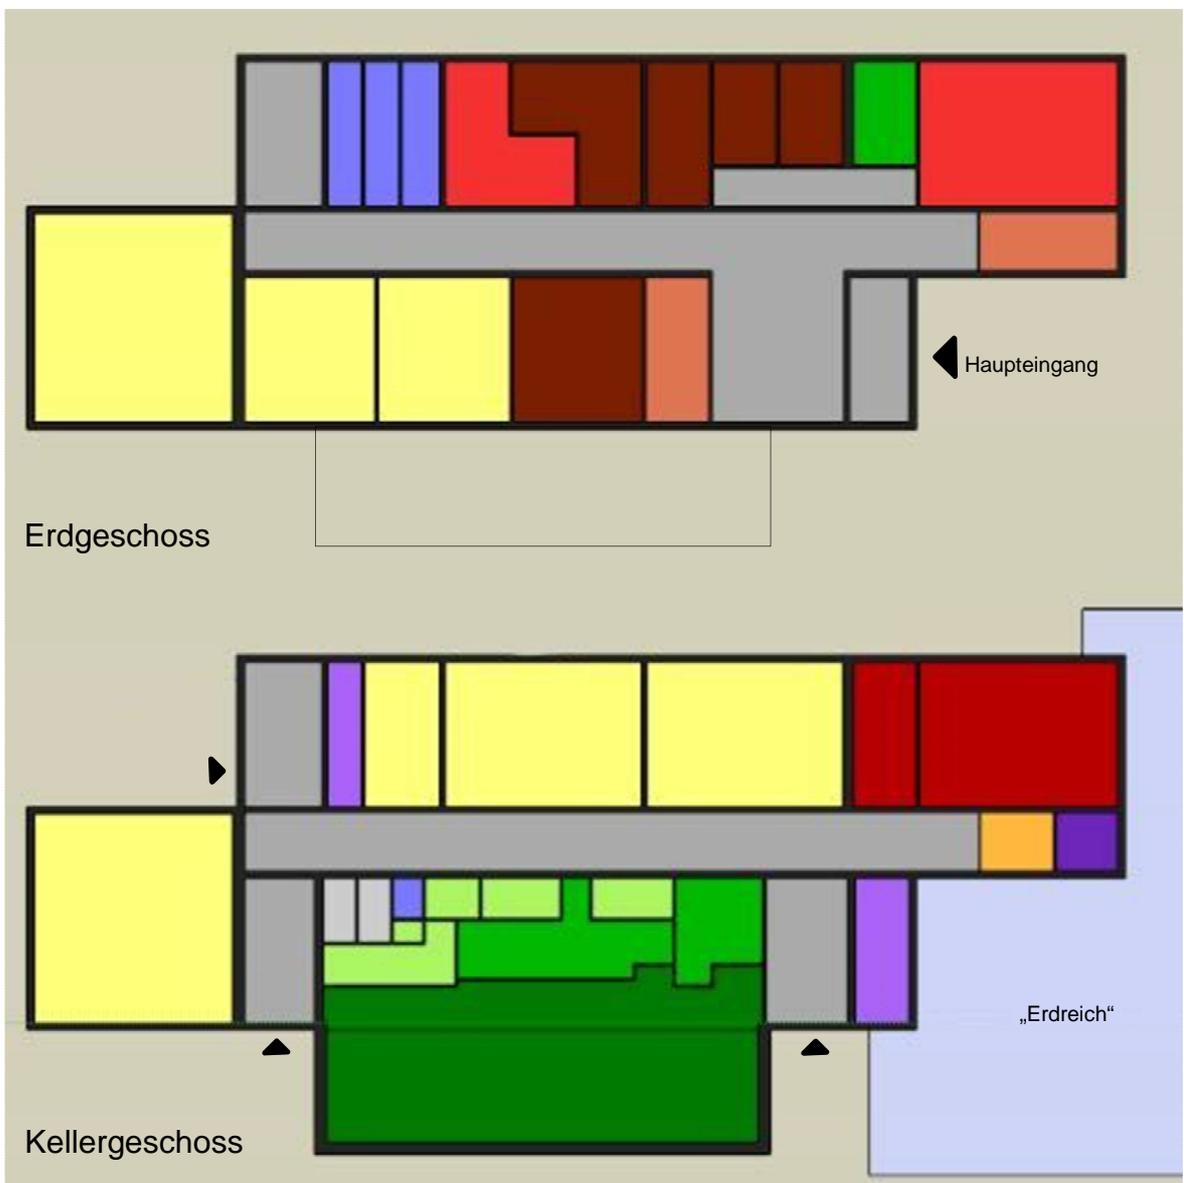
Verwaltungsgebäude, Grundriss mit Zonierung
